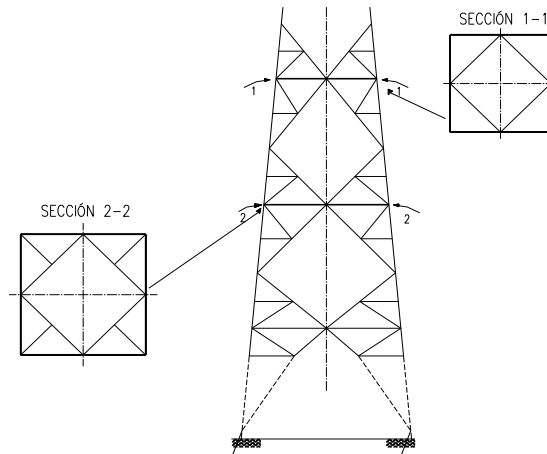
Vista de perfil y vista de planta de los cerramientos de una torre.³²
